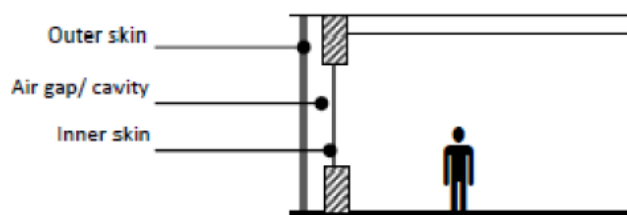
Bangunan Gedung dengan Fasad *Metal Cladding
